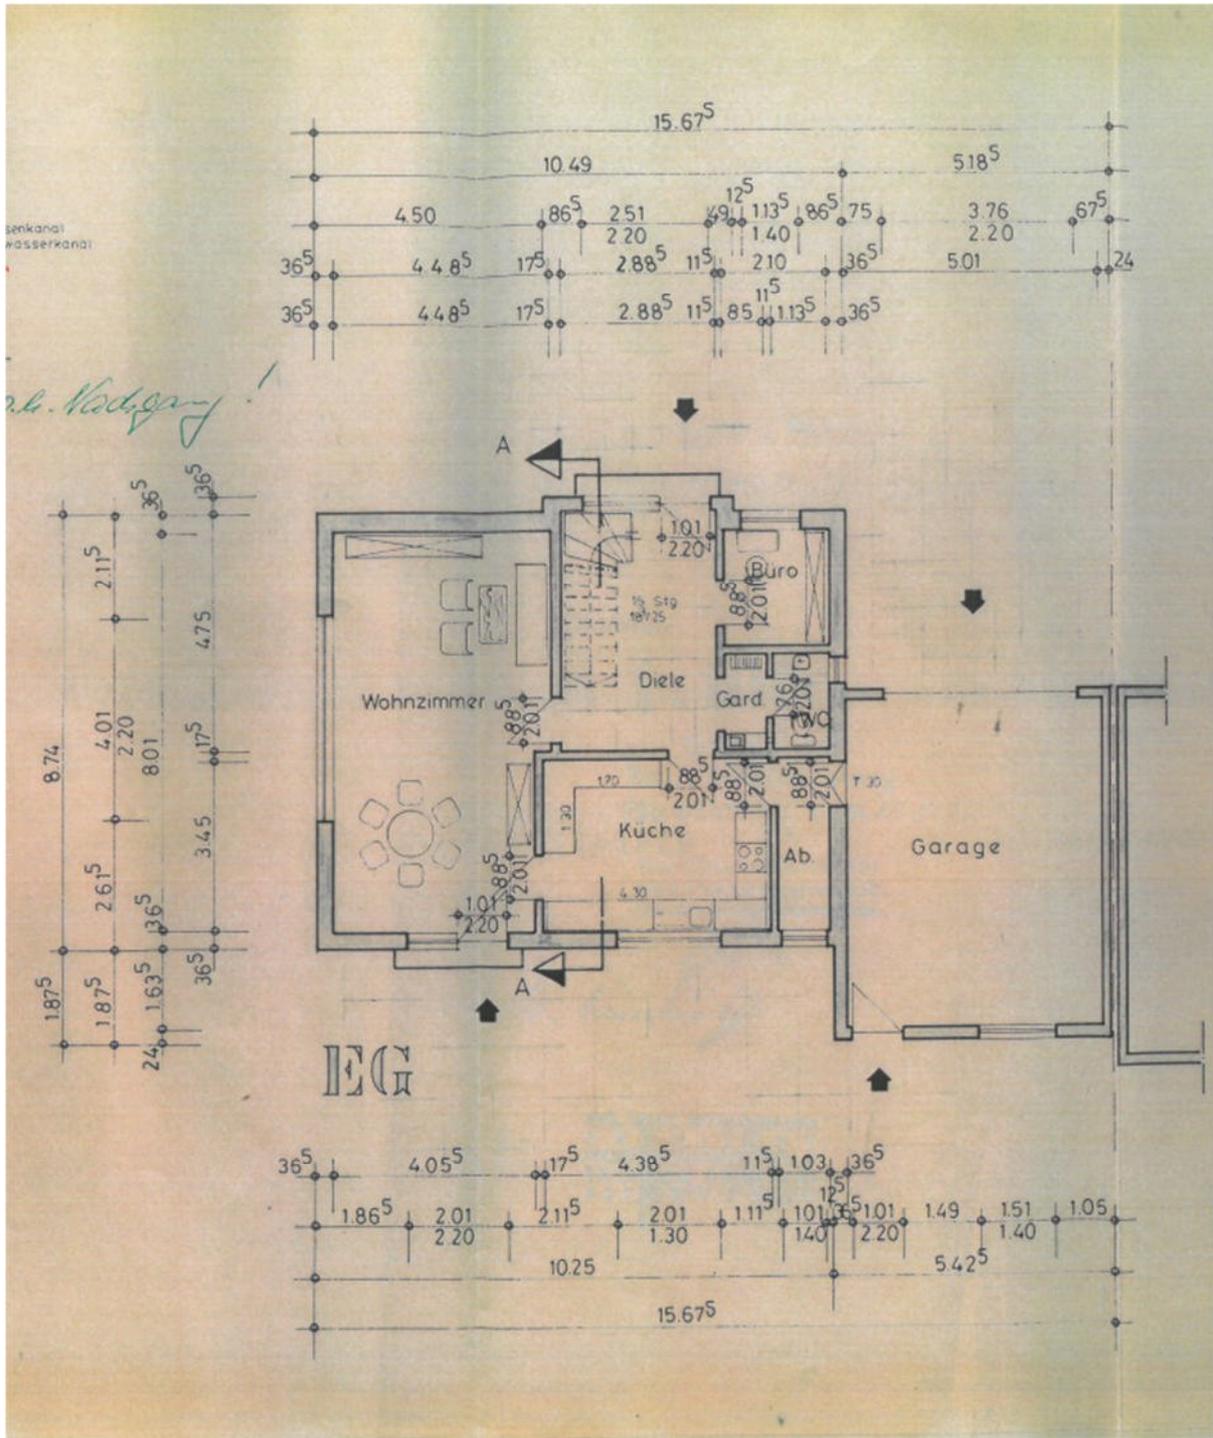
Erdgeschoss / Plan aus der Bauakte Abweichungen vor Ort sind möglich
